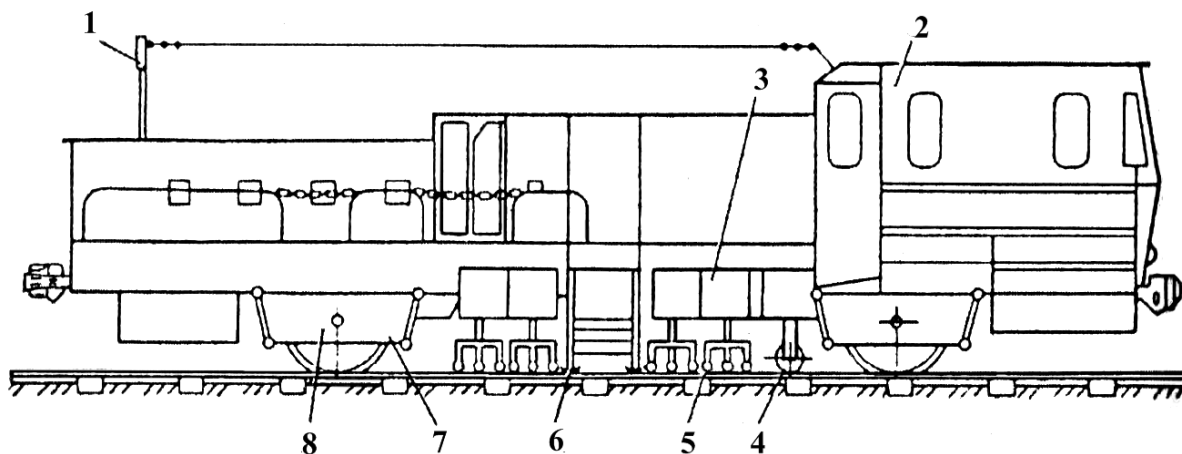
Колійний моторний гайковерт ПМГ:
